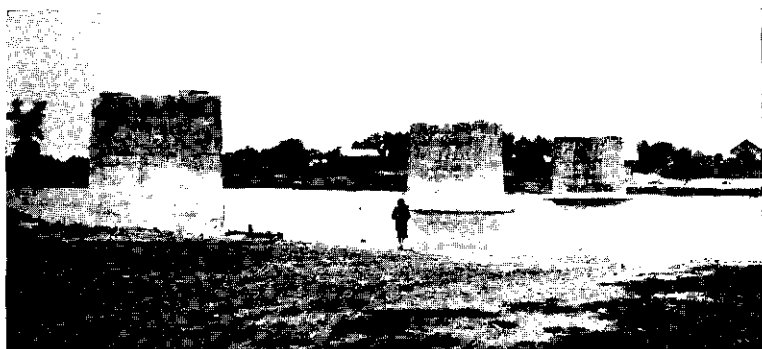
Filary betonowe dla mostu na rz. Sanie w Brandwicy w rozmaitych stadjach budowy.
